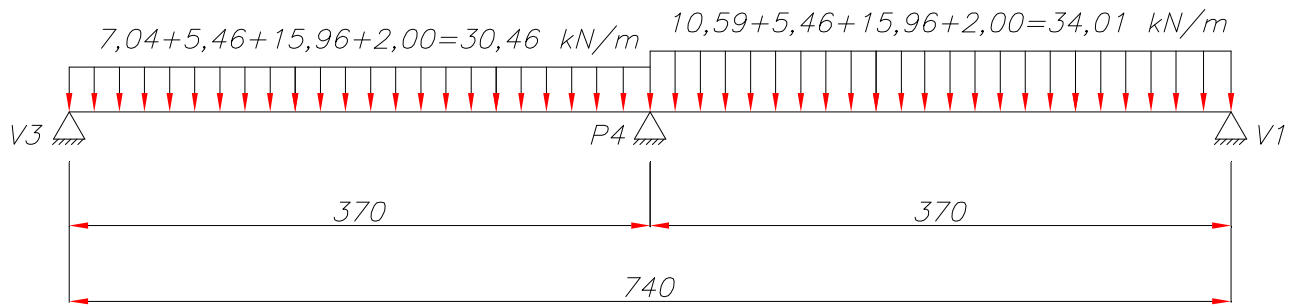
Modelo Estrutural e Carregamento Viga V5
